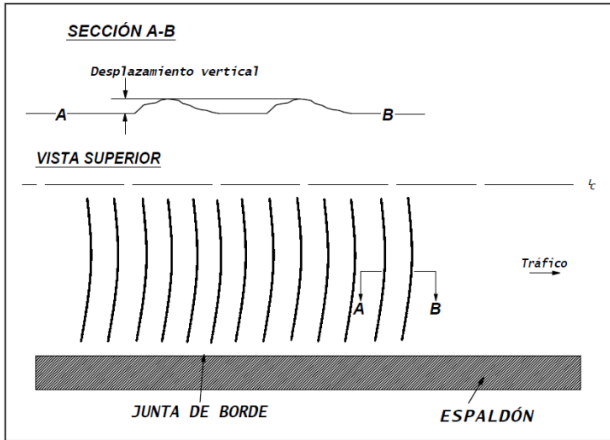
Esquema Corrugación- Pavimento Flexible
